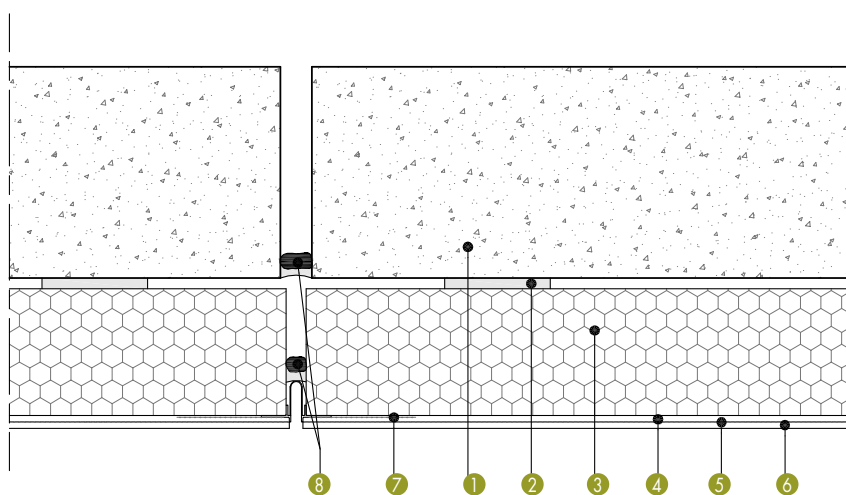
Joint de dilatation - surface plane (coupe horizontale)
